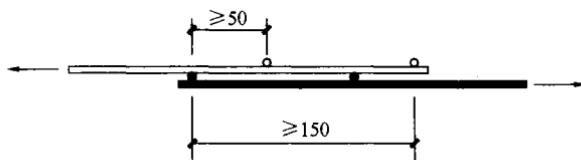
冷拔光面钢筋焊接网搭接接头
